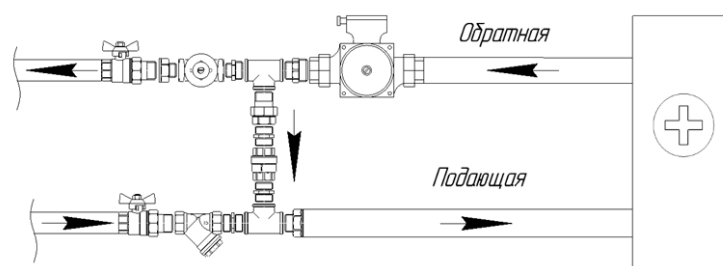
Смесительный узел СТАНДАРТ с двухходовым клапаном на резьбовом присоединении
